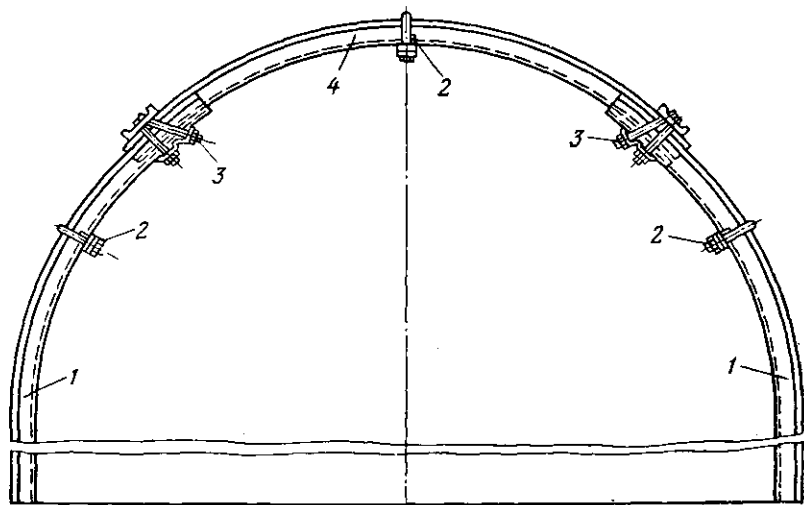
Металлическая арочная трёхзвенная податливая крепь с прямыми концами стоек: 1 – стойка; 2 – стяжка; 3 – соединительный узел из заблокированных скоб; 4 – верхняк
